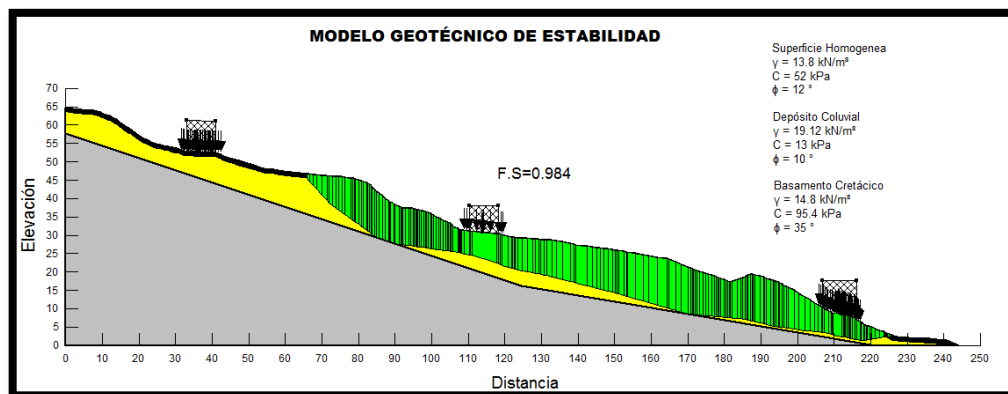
Cargas de la infraestructura vial sobre el perfil.
